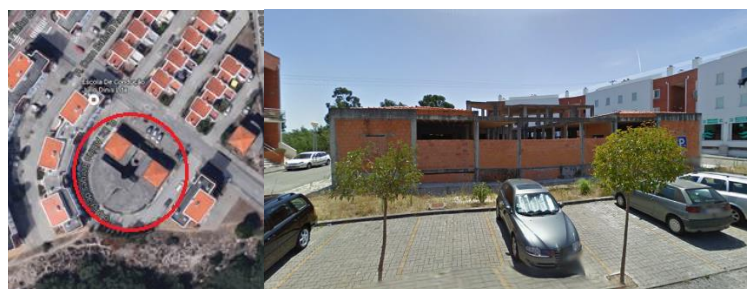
Localização Parcela D102 na área de intervenção do Plano de Pormenor.
